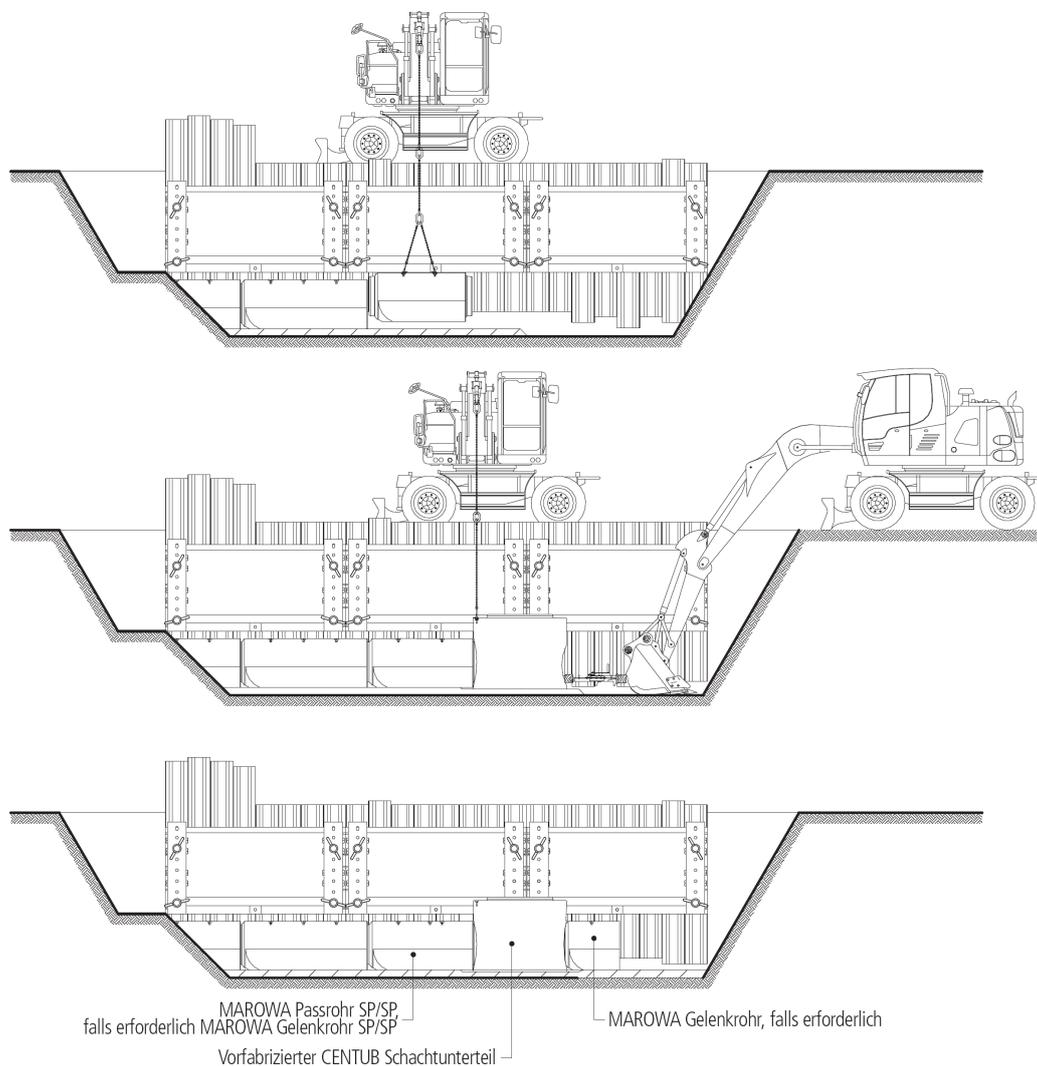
Möglicher Bauablauf mit Einbau von vorfabrizierten CENTUB® Schachtunterteilen
